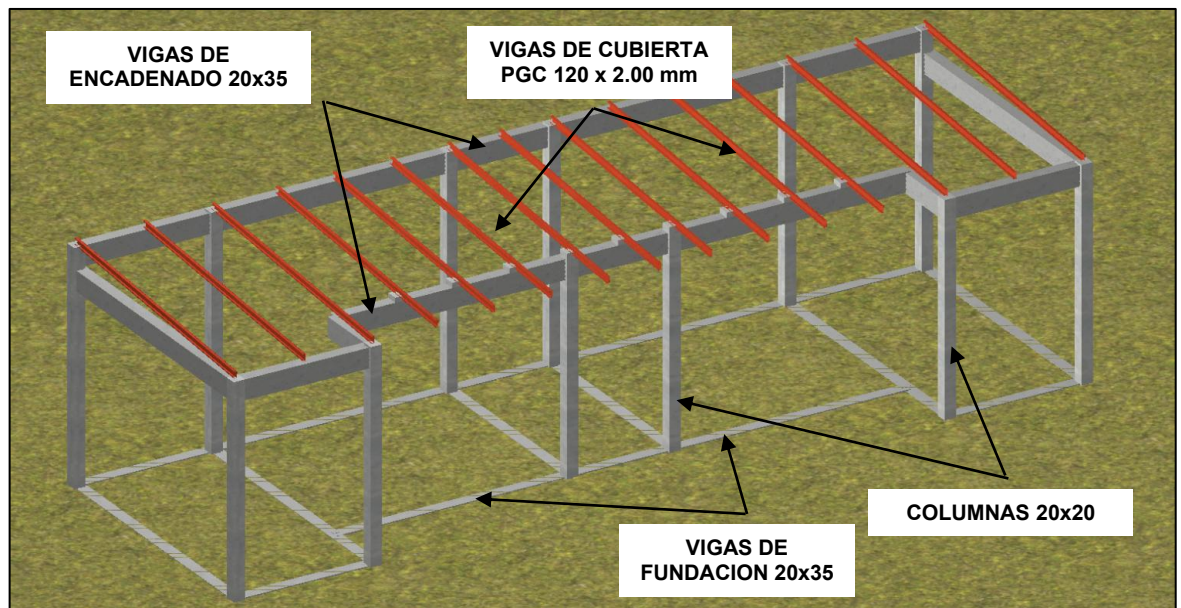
ESTRUCTURA DE HORMIGÓN SOBRE FUNDACIÓN
